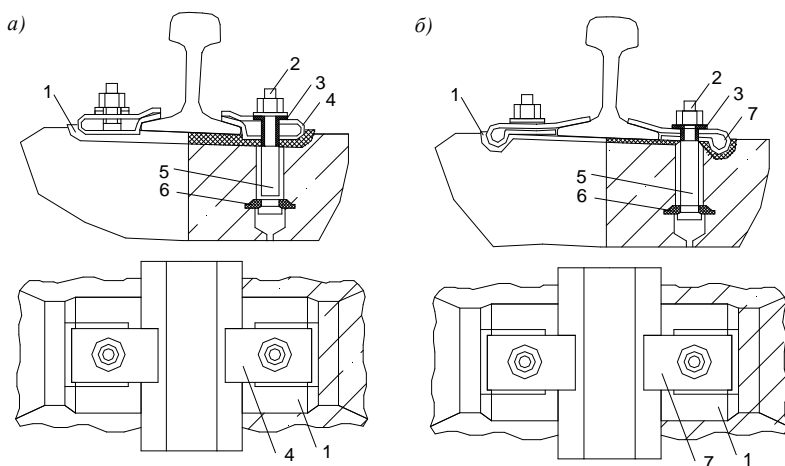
Нераздельное крепление для железобетонных шпал:
